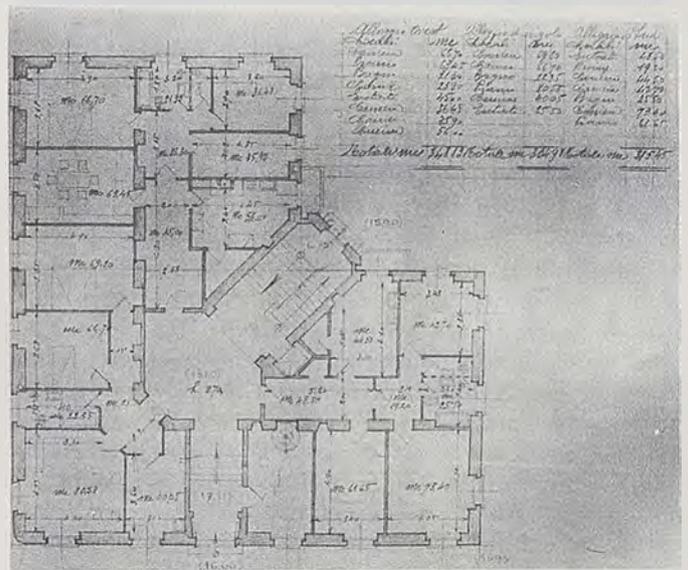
a - Casa Carpano: pianta del piano rialzato
